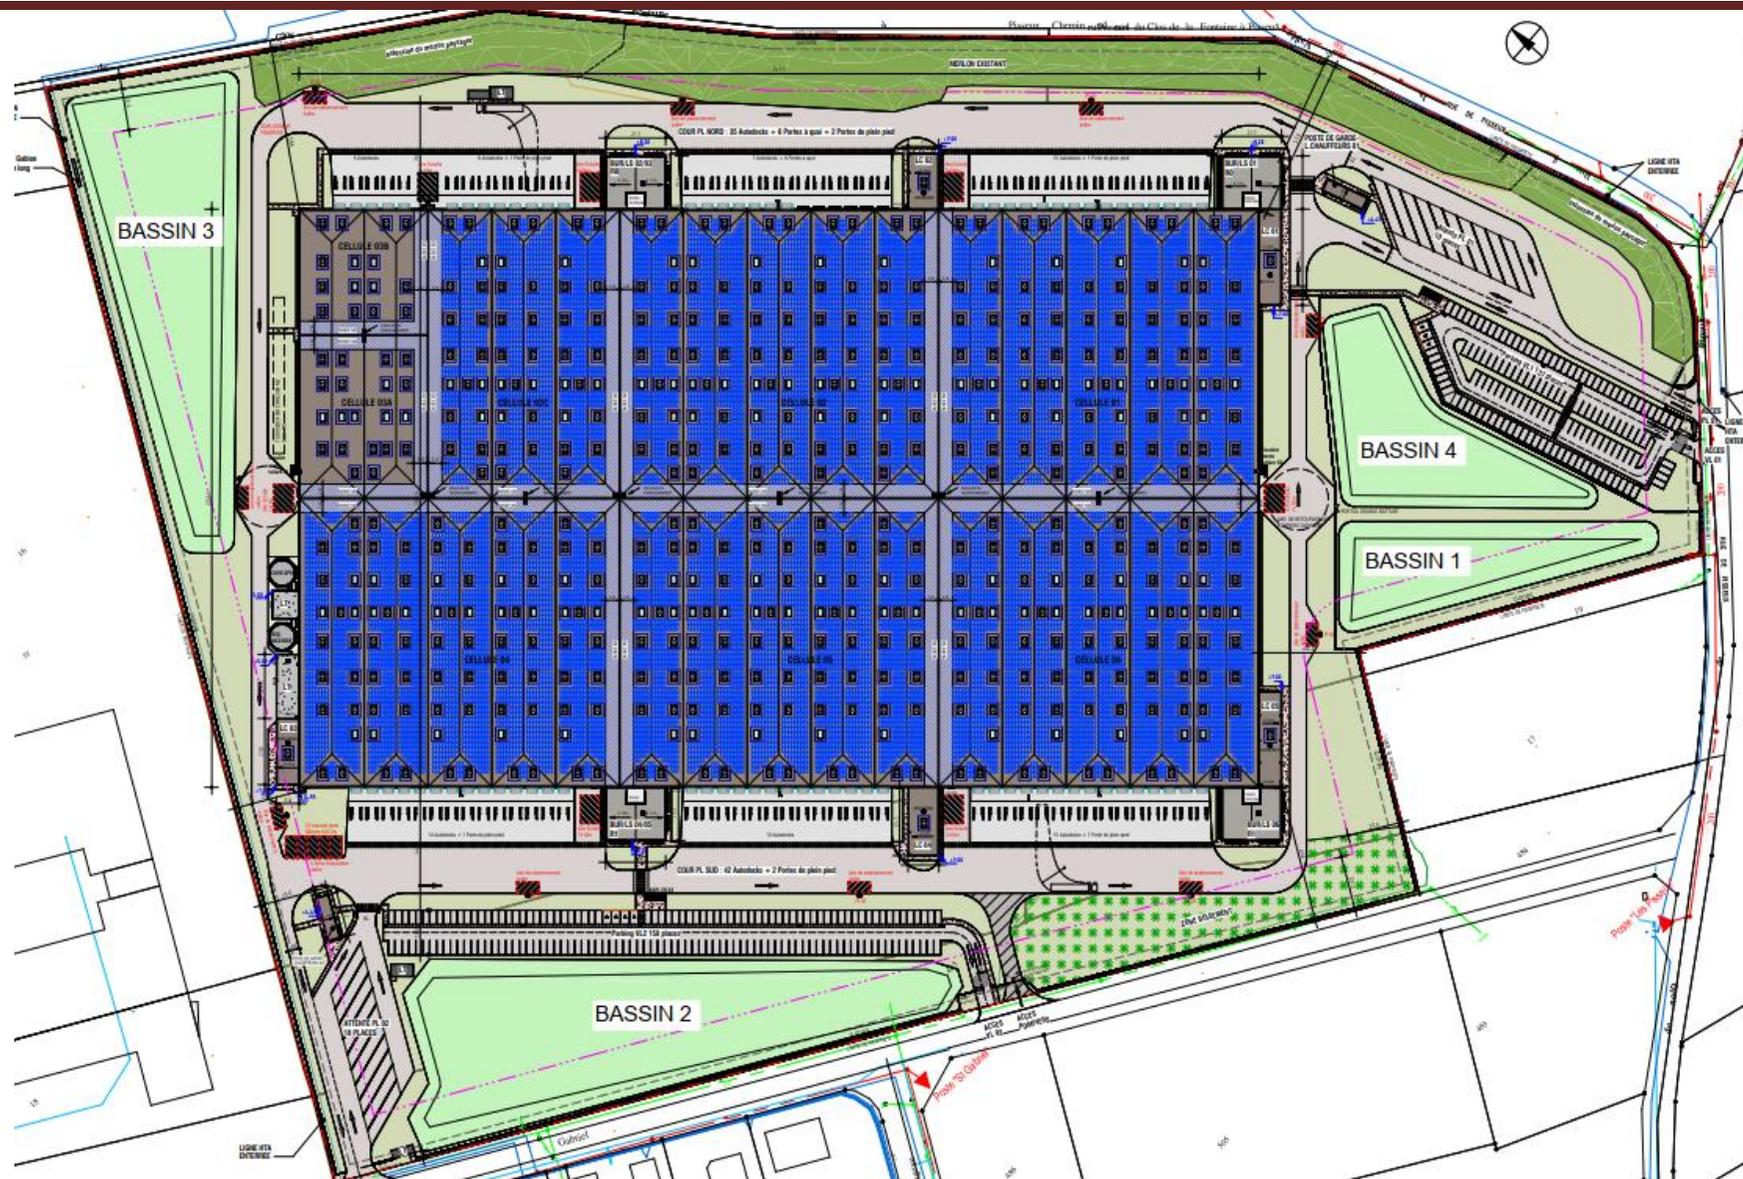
Plan de masse du projet : 17,6871 Ha
